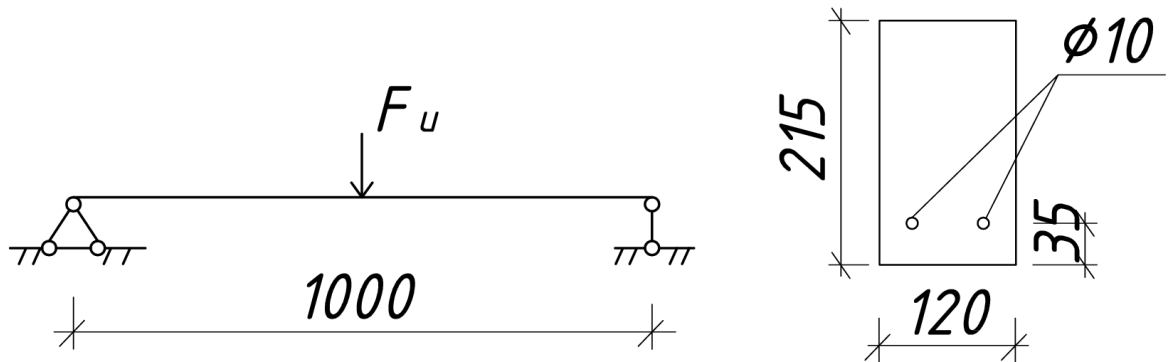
Железобетонная балка и ее расчетная схема
